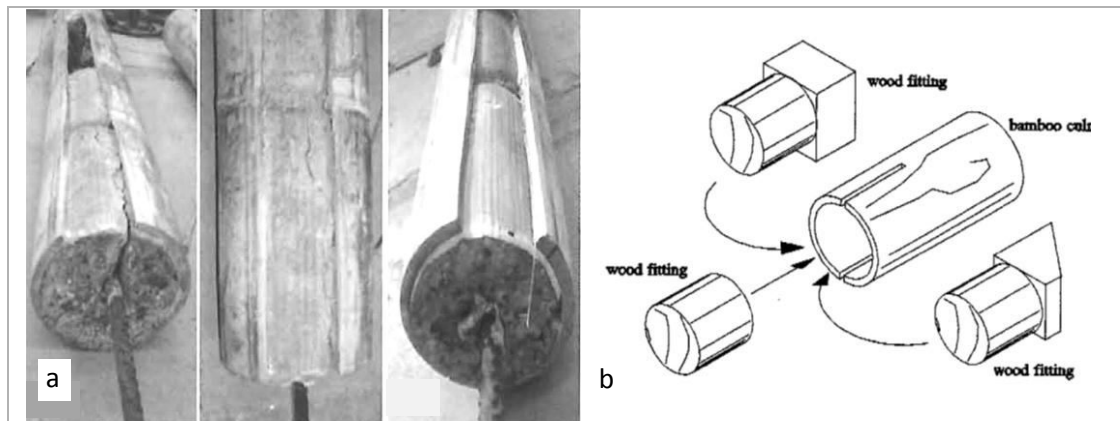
a) Betonfüllung mit Polyurethan-Haftbrücke nach Garrecht (16). b) Vorschlag von Holzfittings als Füllkörper nach Acre-Villalobos (17).
